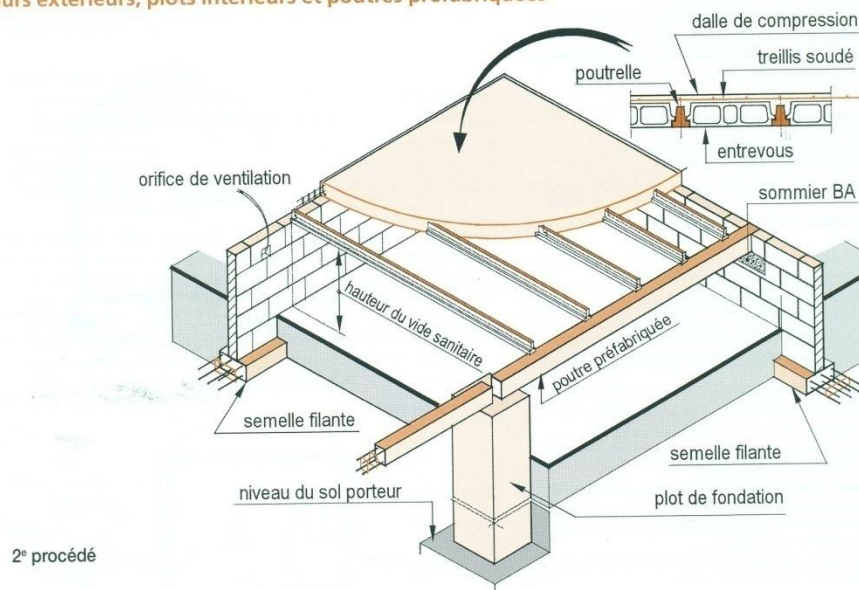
Poutres préfabriquées qui s'appuient sur les murs de rive et sur les plots
